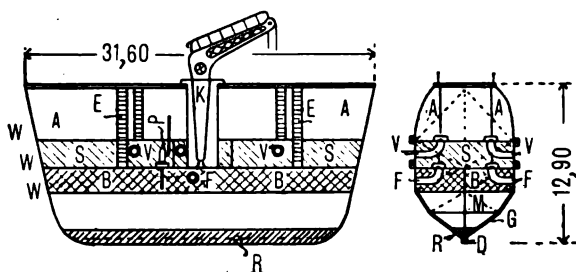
Verschlußponton des Kaiserdocks in Bremerhaven.
